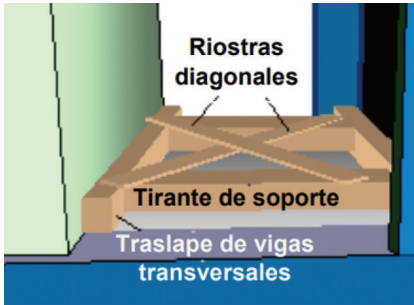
Medio de soporte con el traslape de las vigas transversales y riostras diagonales
